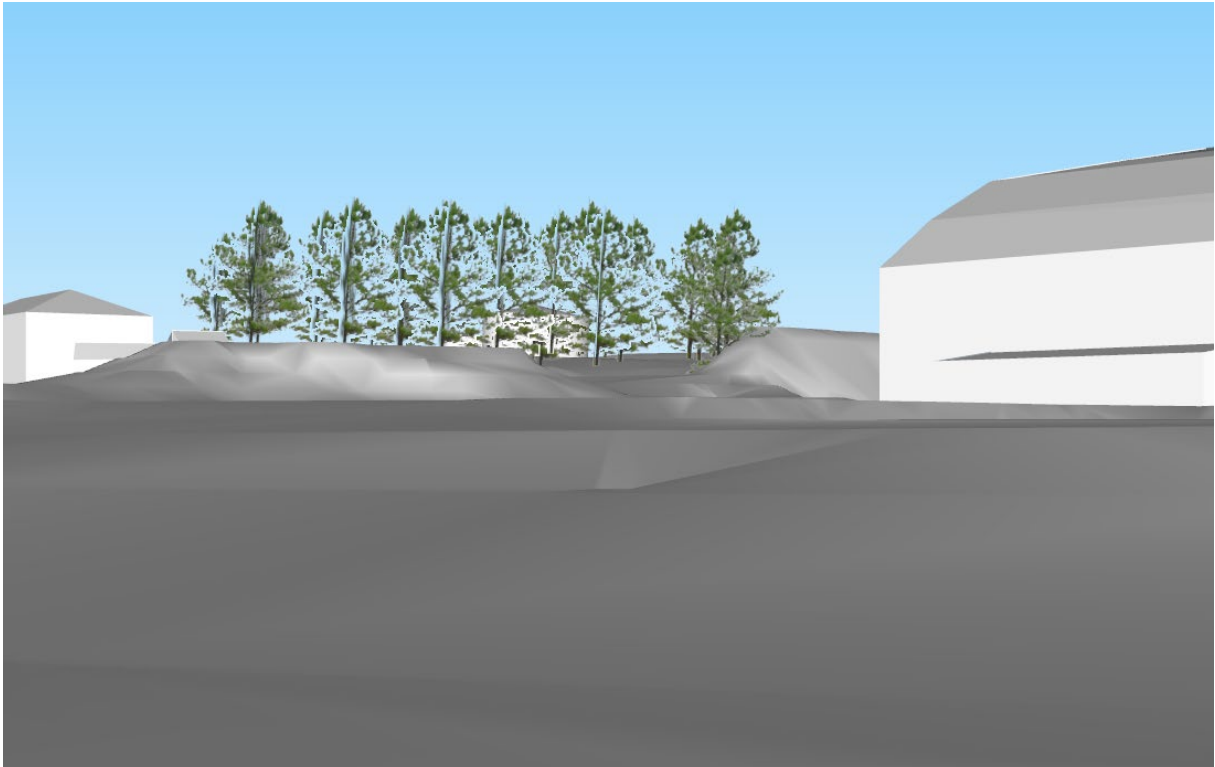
Illustrasjonsfoto høydebasseng – fasade
